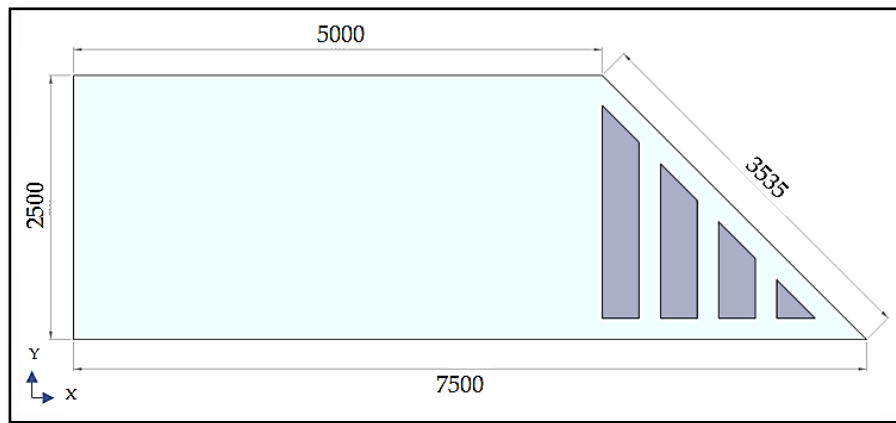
Geometría de un muro Trombe Escalonado, Caso N° 9. Medidas en milímetros.
